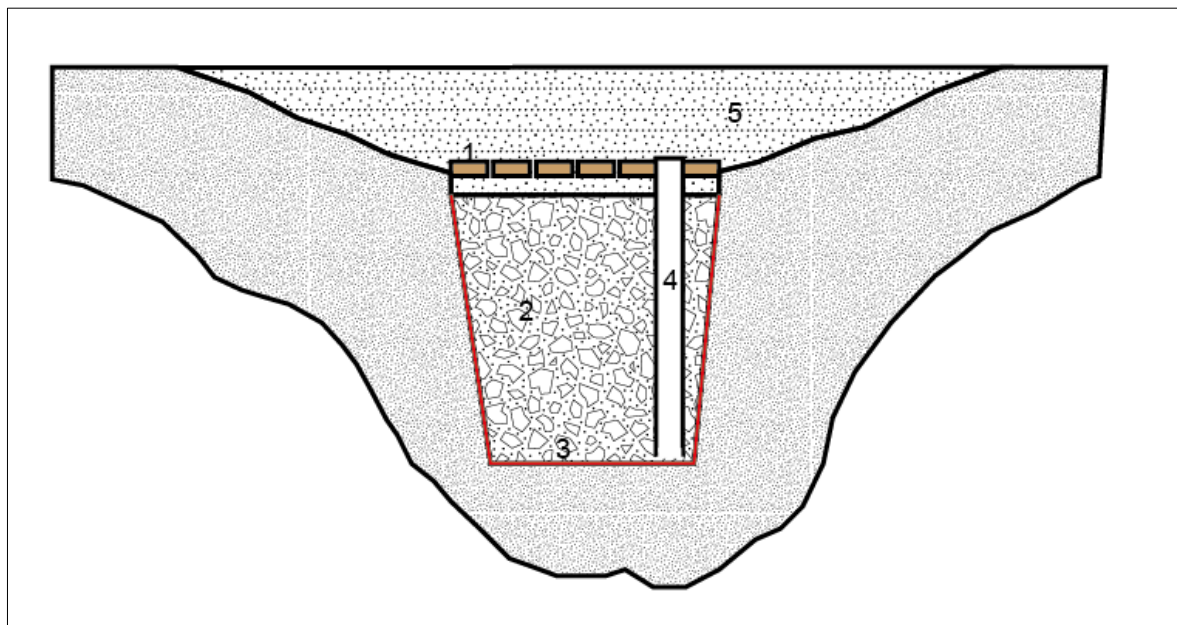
Pozo de infiltración simple alimentado desde la superficie. 1) Cubierta permeable, 2) Relleno, 3) Geotextil (línea roja), 4) Piezómetro, 5) Almacenamiento superficial. Fuente: modificado de MINVU, 1996.
